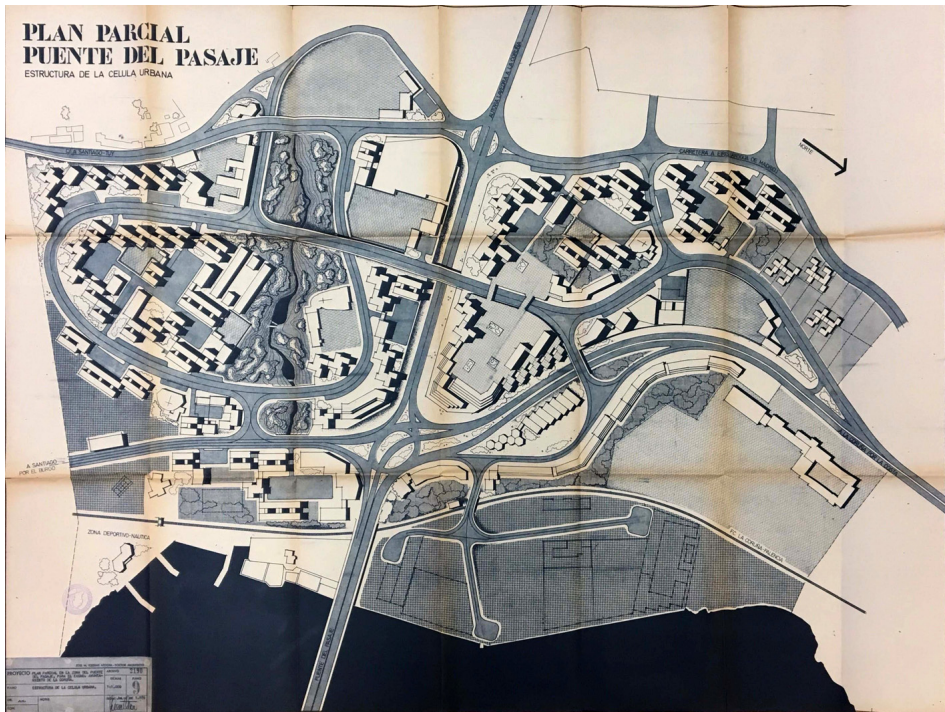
Plano General Plan Parcial del Pasaje. Fuente: Archivo General de Fomento.
